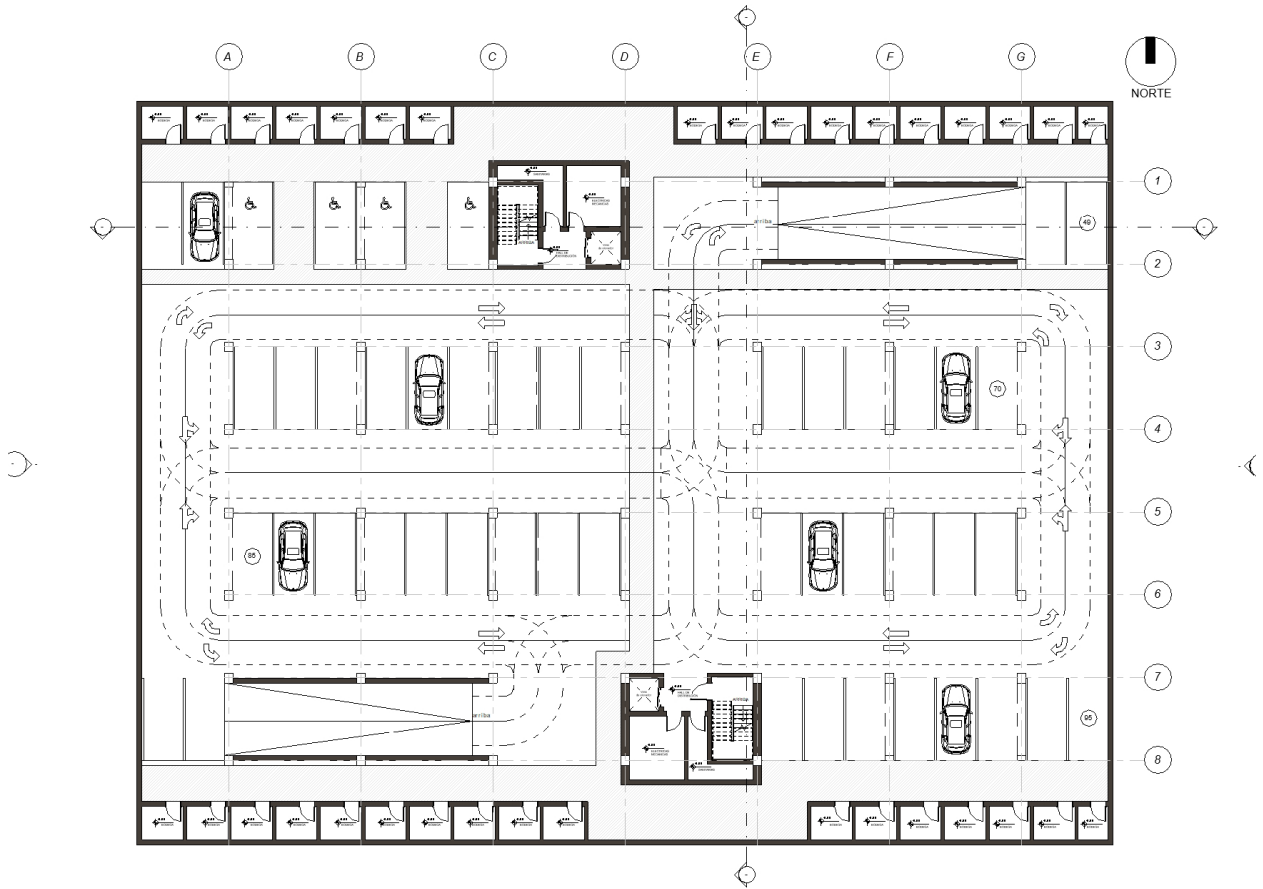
Planta Arquitectónica: Subsuelo I.
